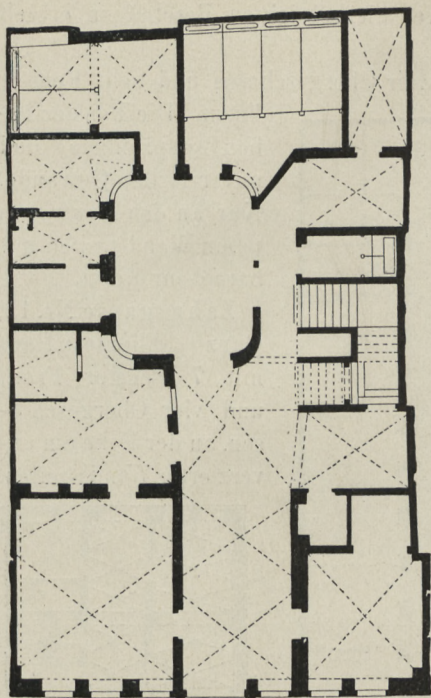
Kleine Brüdergasse Nr. 19. Erdgeschoss.
